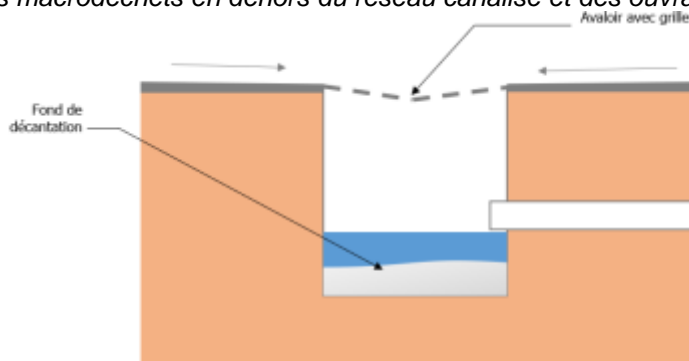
Coupe de principe d'un avaloir à grille avec fond de décantation
